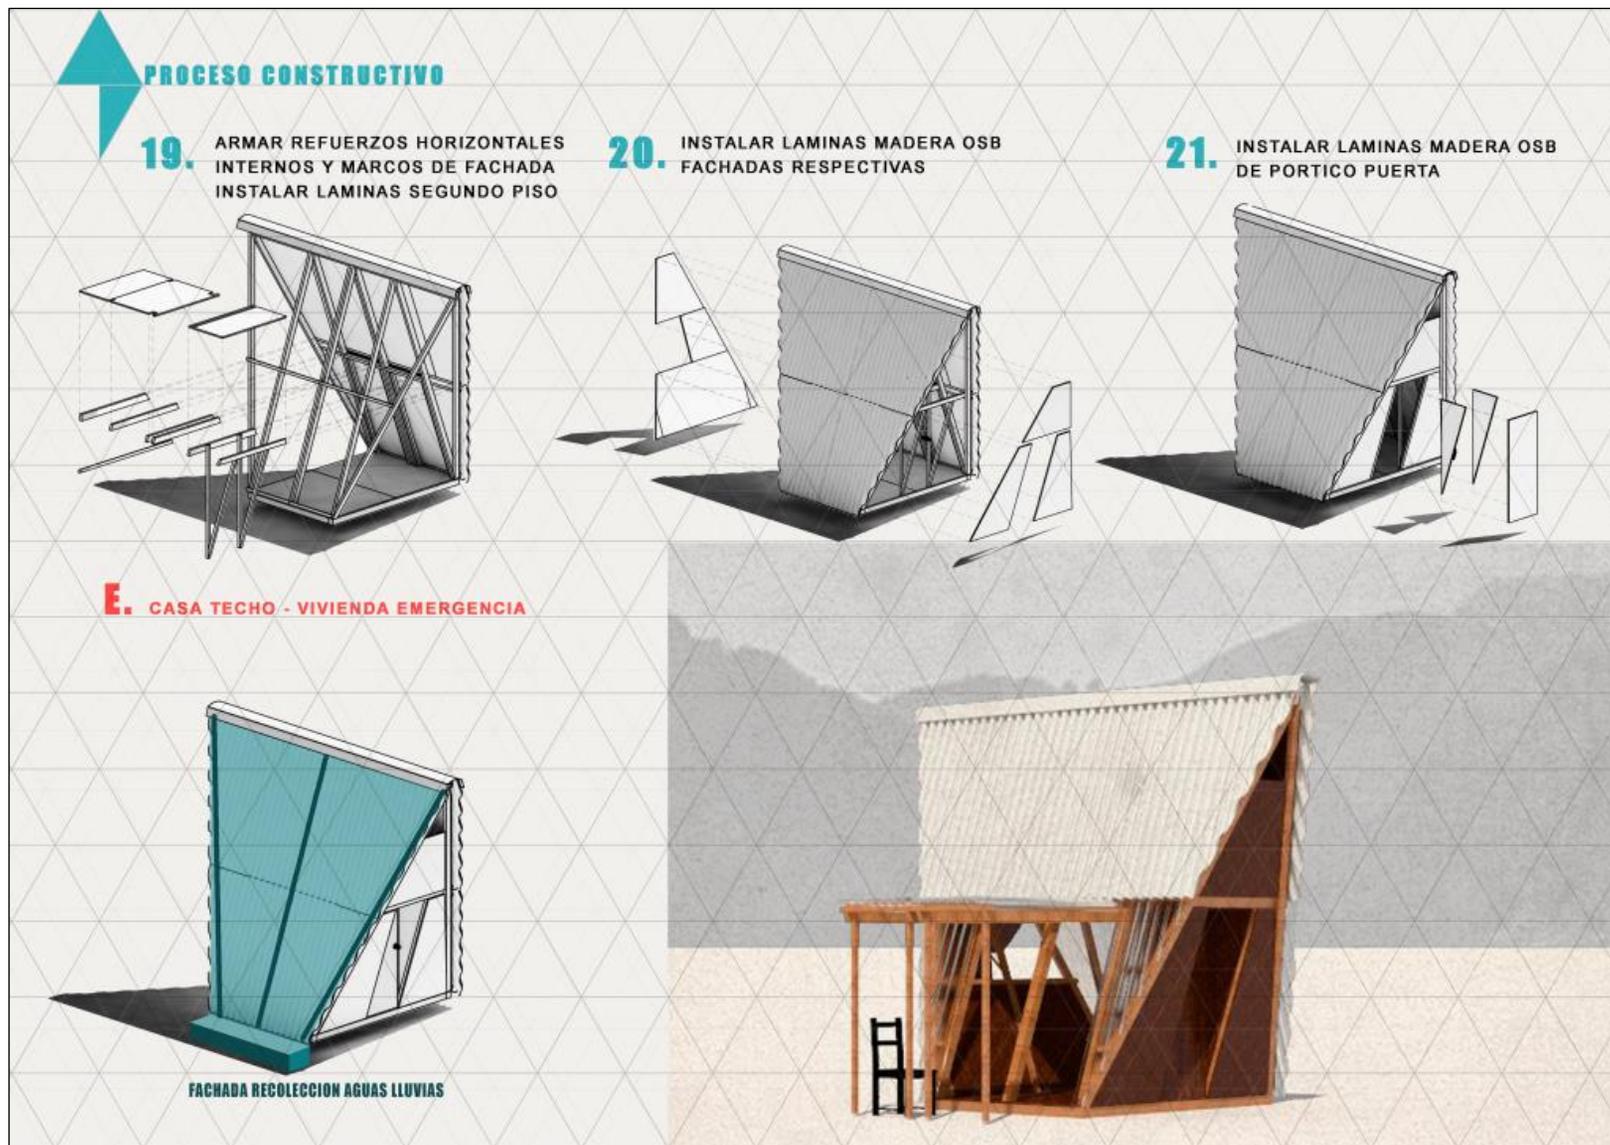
Proceso de armado de la vivienda emergente Casa Techo
